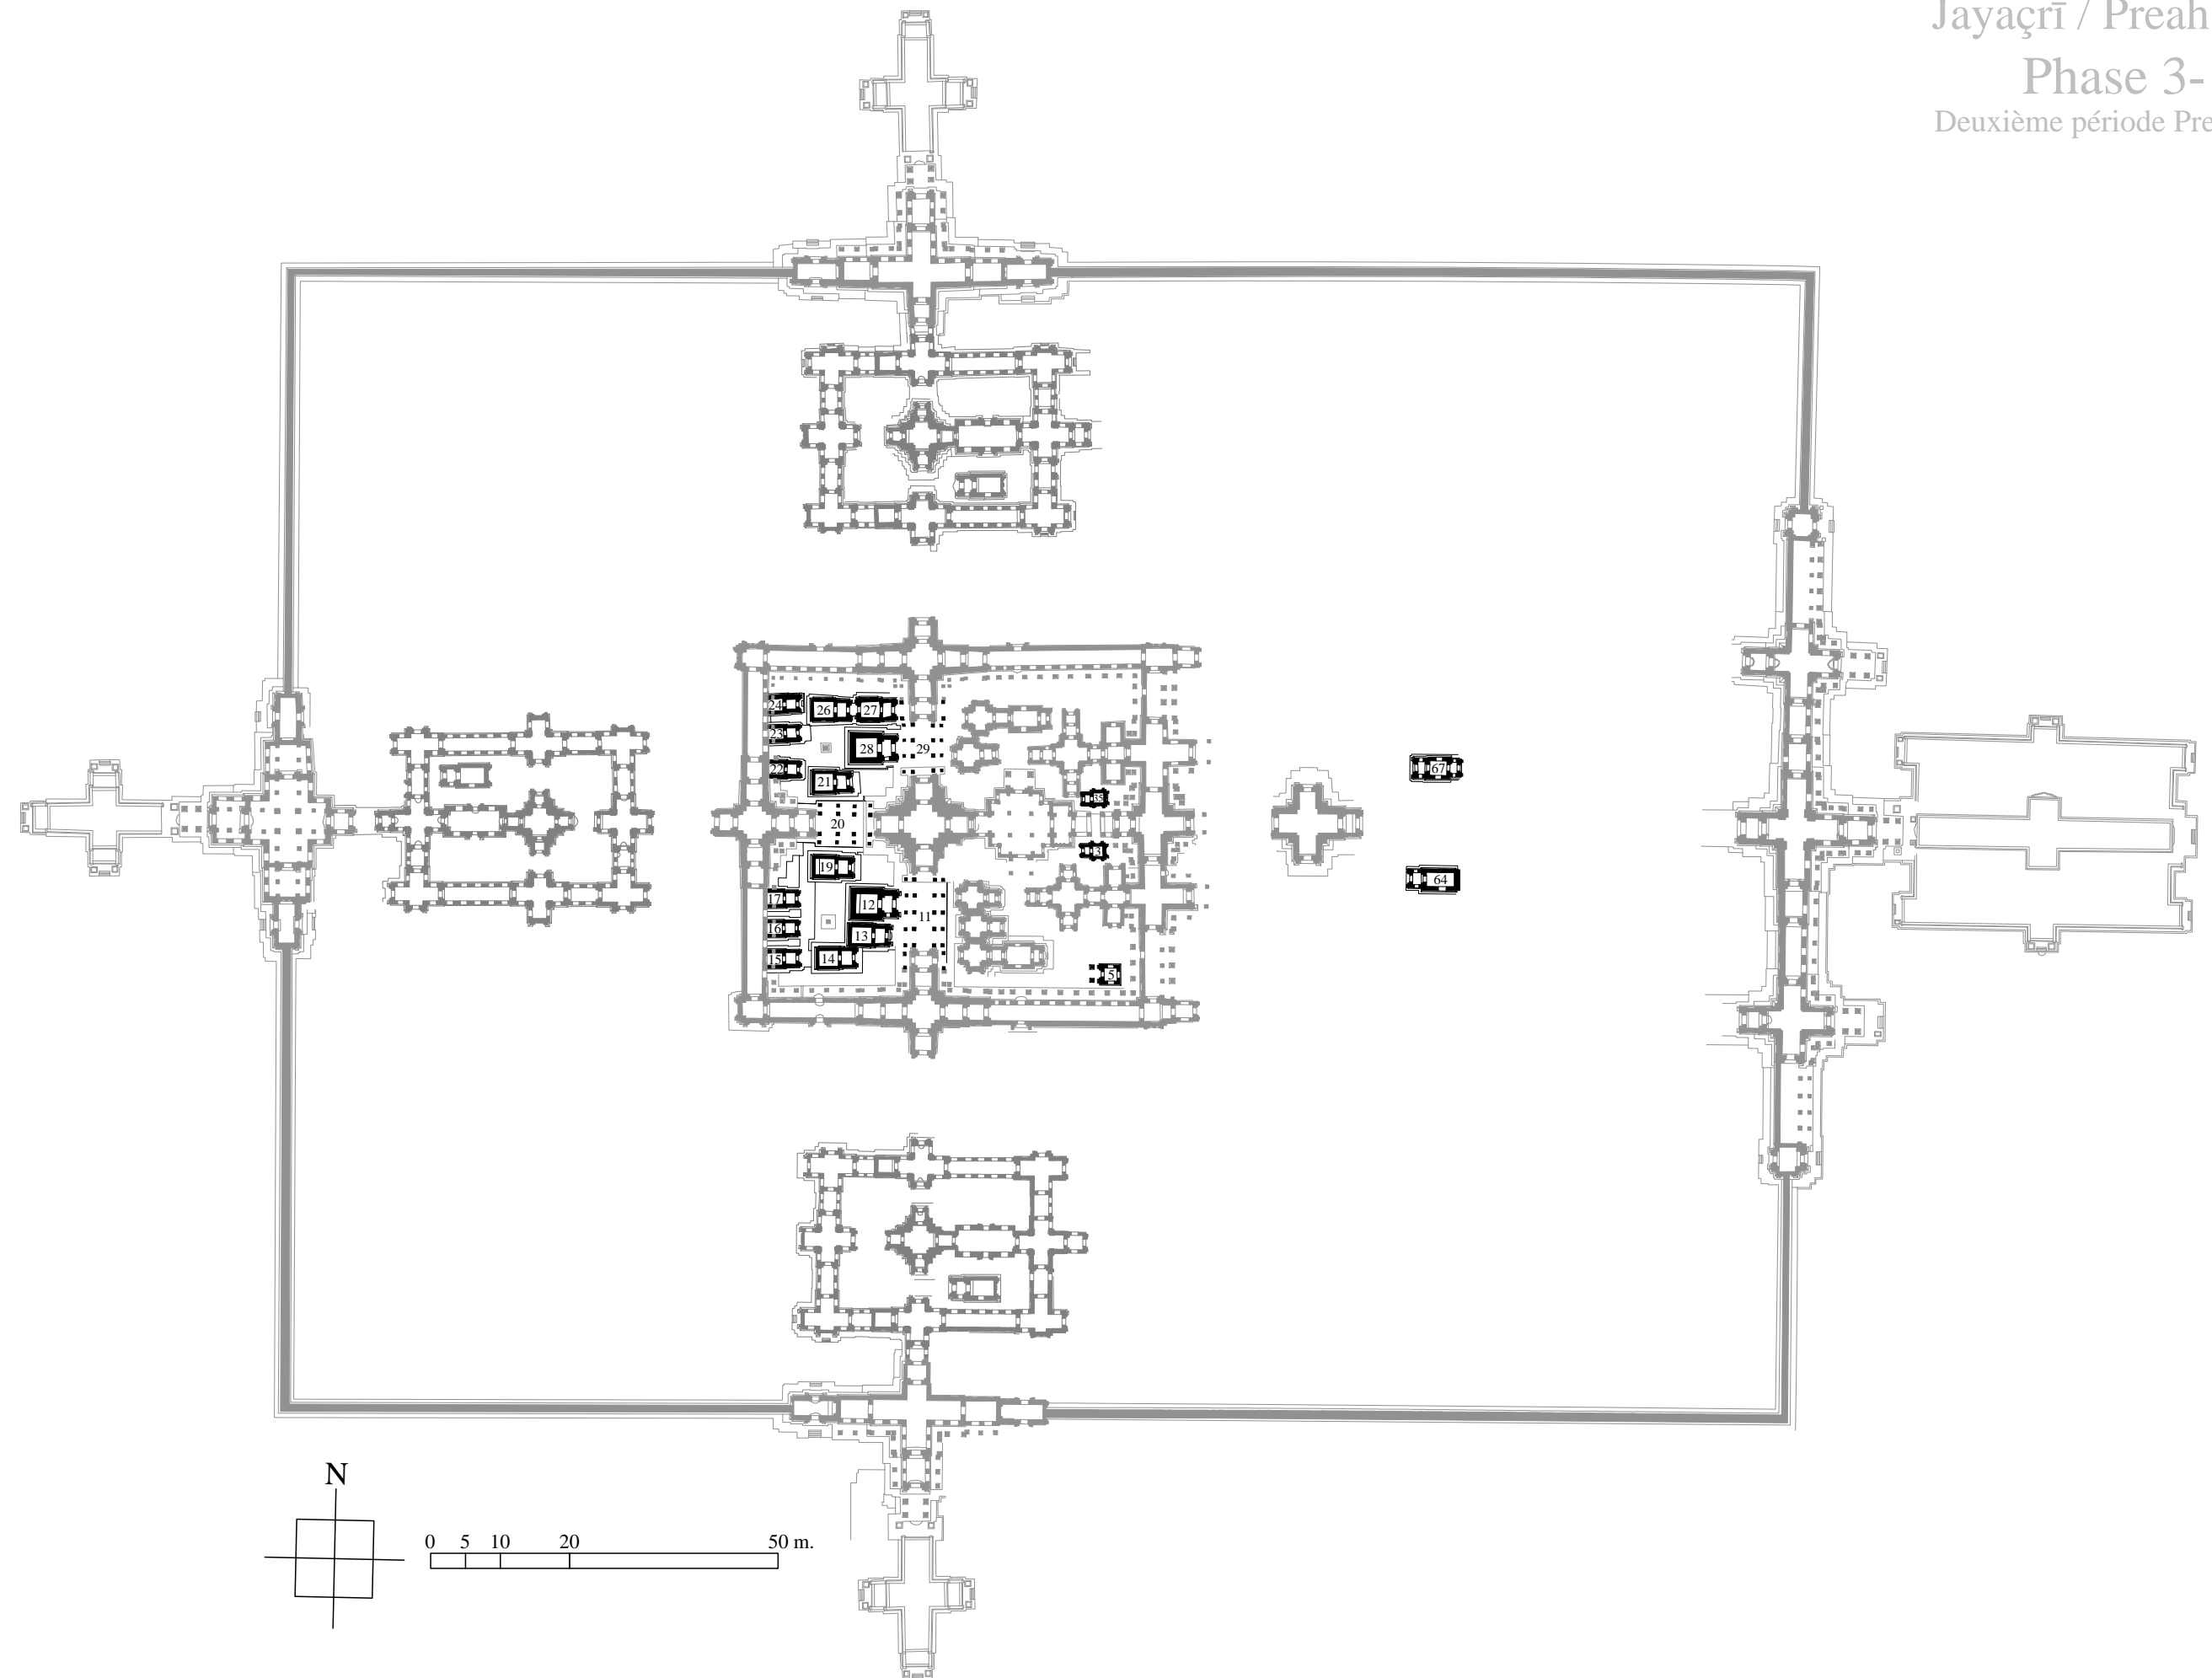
Premier état de la troisième tranche des travaux de Jayaçrī (Preah Khan d'Angkor)
